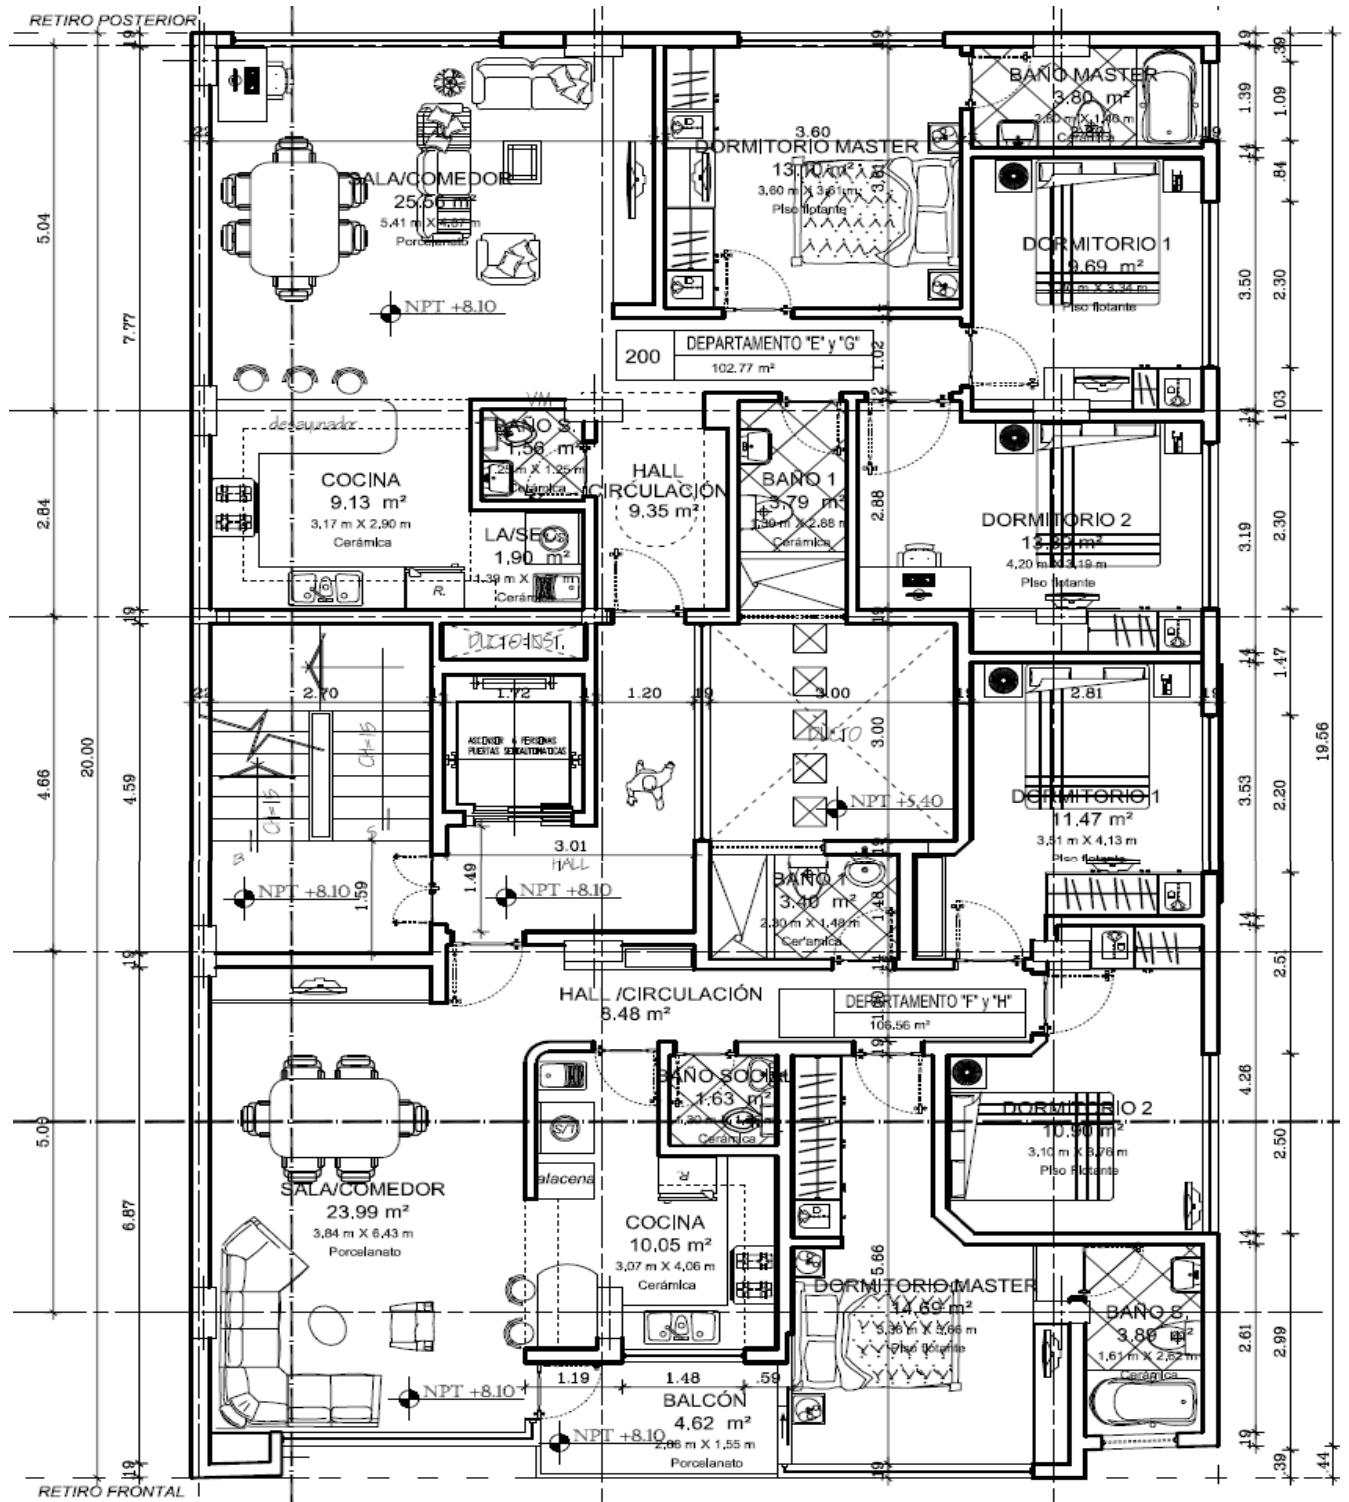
Planta tipo 1, 2, 3: departamento 3 dormitorios.
